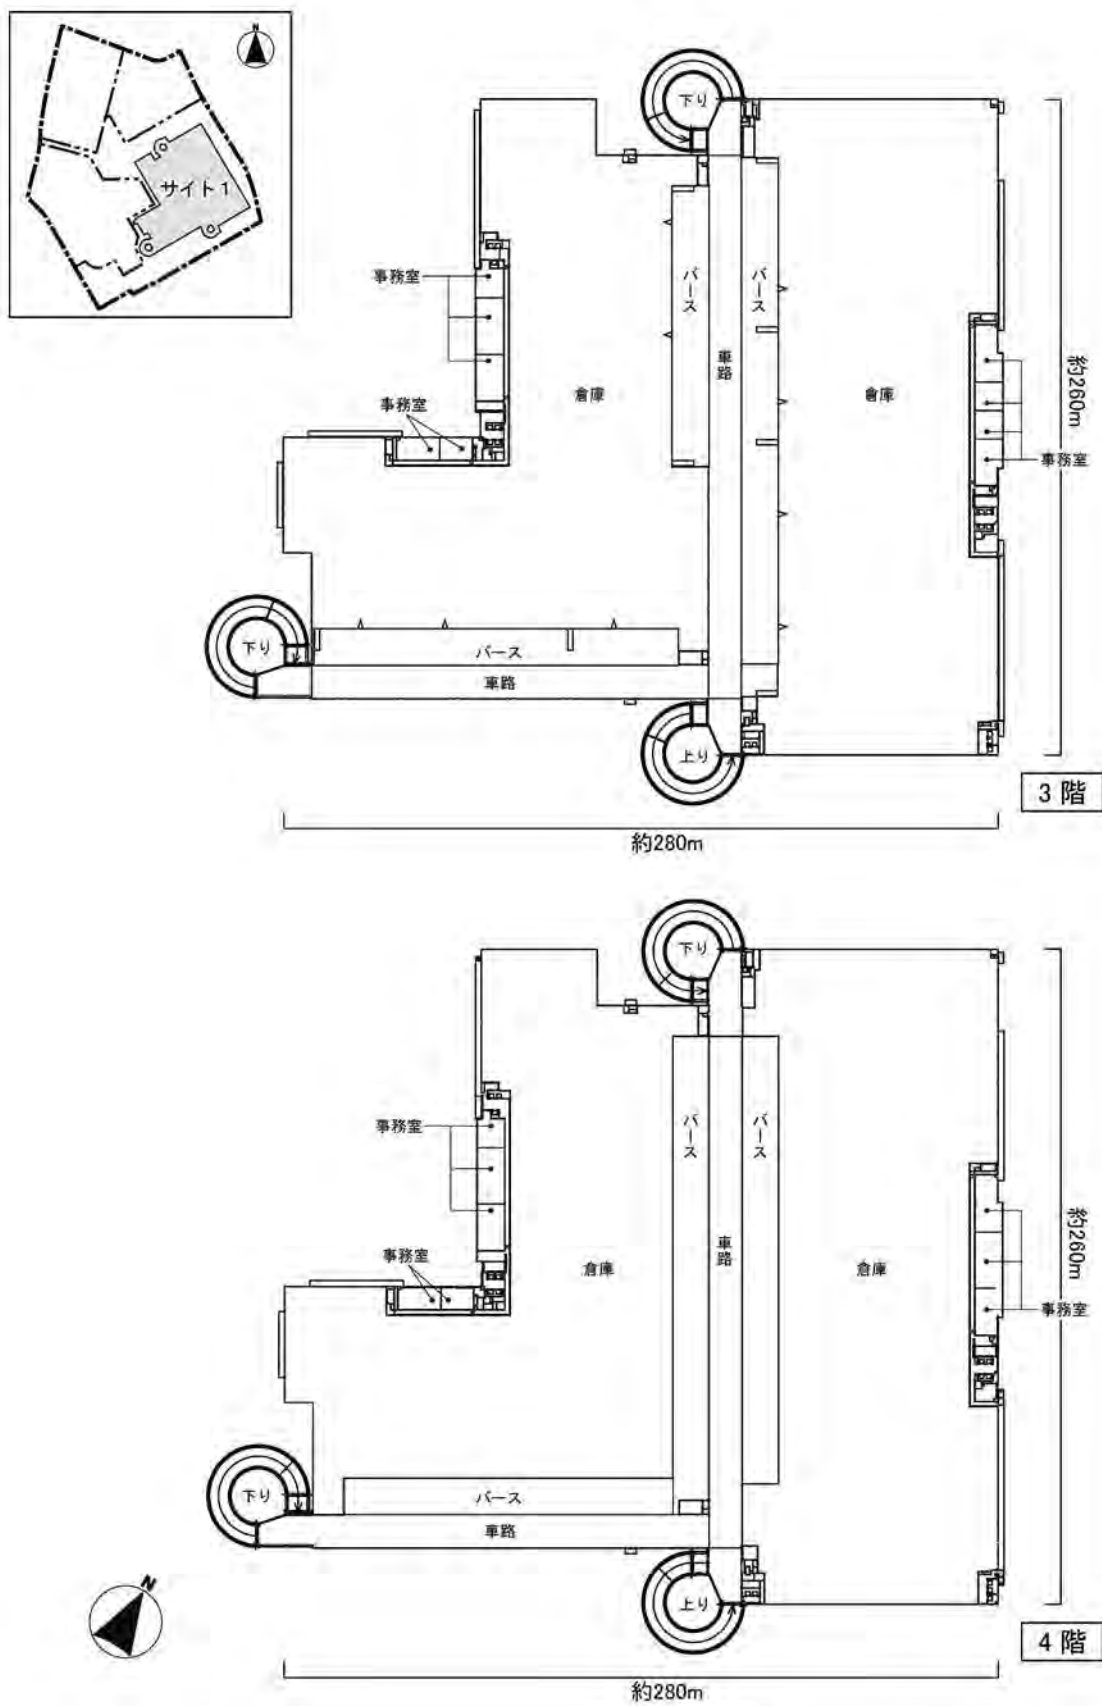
(2) 平面図 (サイト1【3階・4階】)
